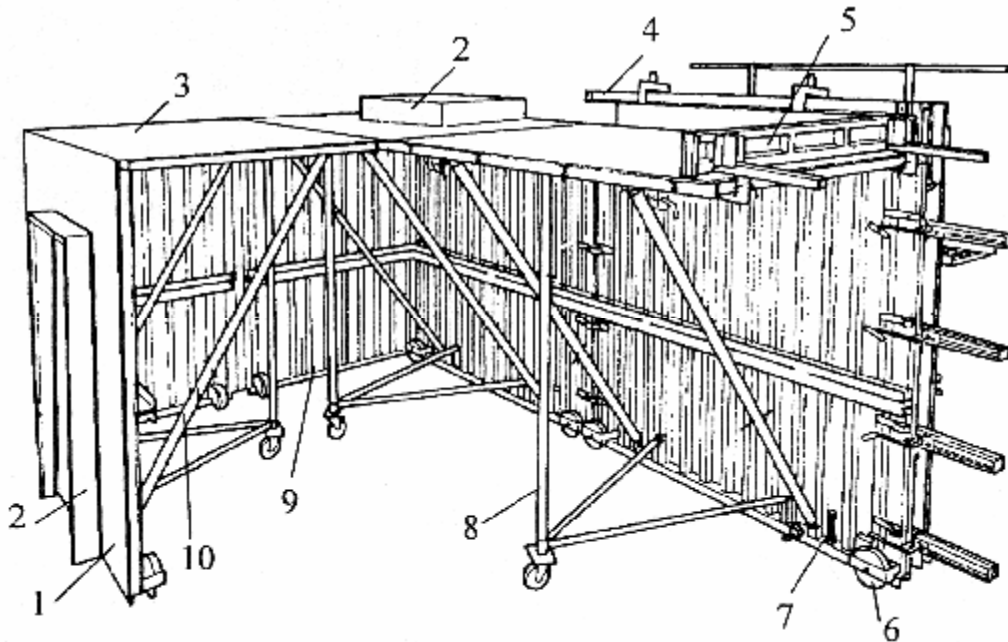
Тунельна опалубка фірми «Утінор»: 1 – вертикальна панель; 2 – отвороутворювачі з магнітними зачіпками; 3 – горизонтальна панель; 4 – опалубка для бетонування цоколя; 5 – торець огорожувальної стінки опалубки; 6 – роликове колесо; 7 – регулювальний домкрат; 8 – центральний опорний стояк; 9 – задня панель; 10 – підкіс
